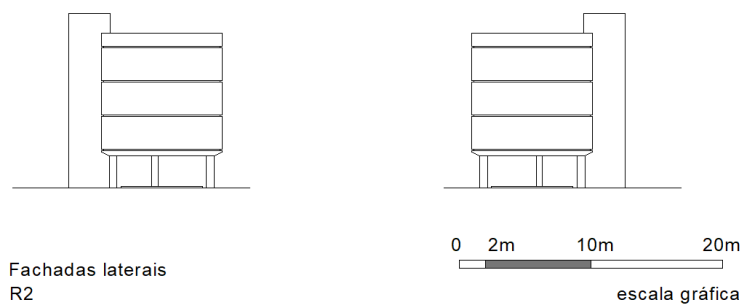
Fachadas laterais do R2. Fonte: da autora, adaptado das pranchas originais do Acervo do Arquiteto Milton Ramos.
